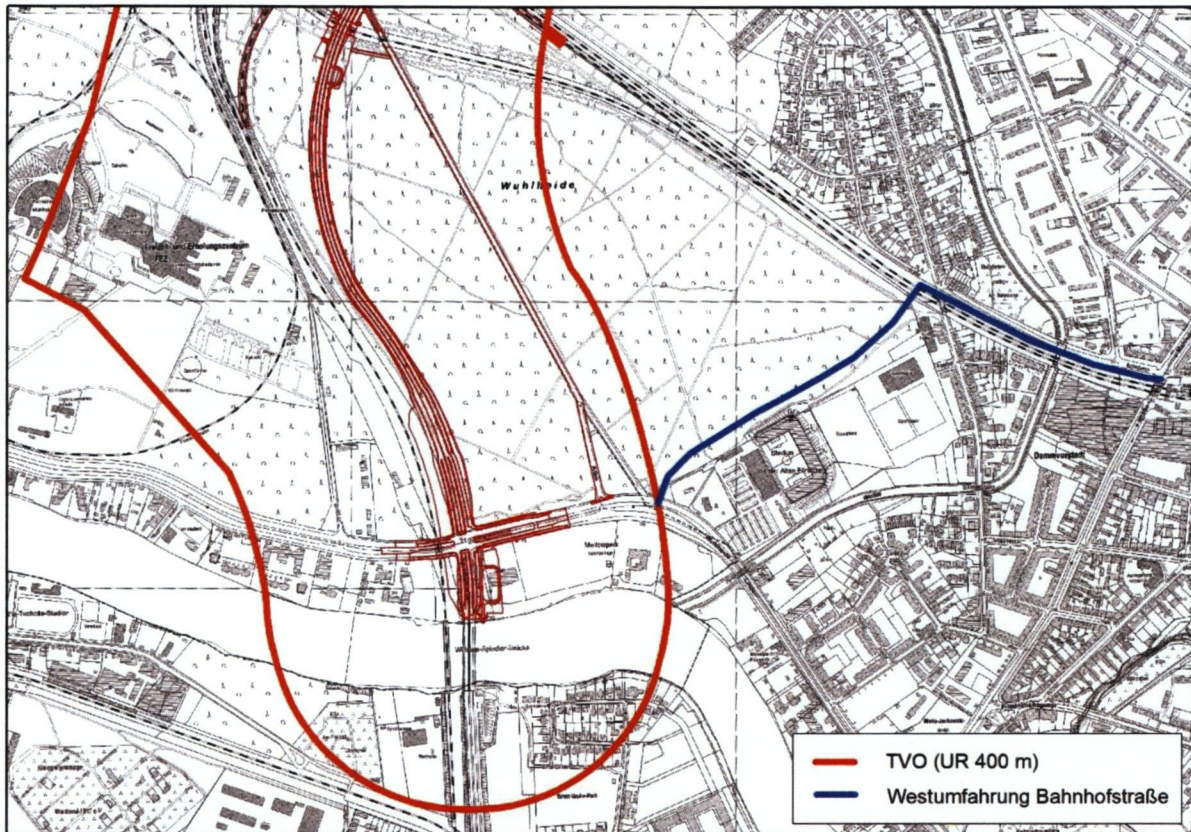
Lage der geplanten Westumfahrung der Bahnhofstraße
